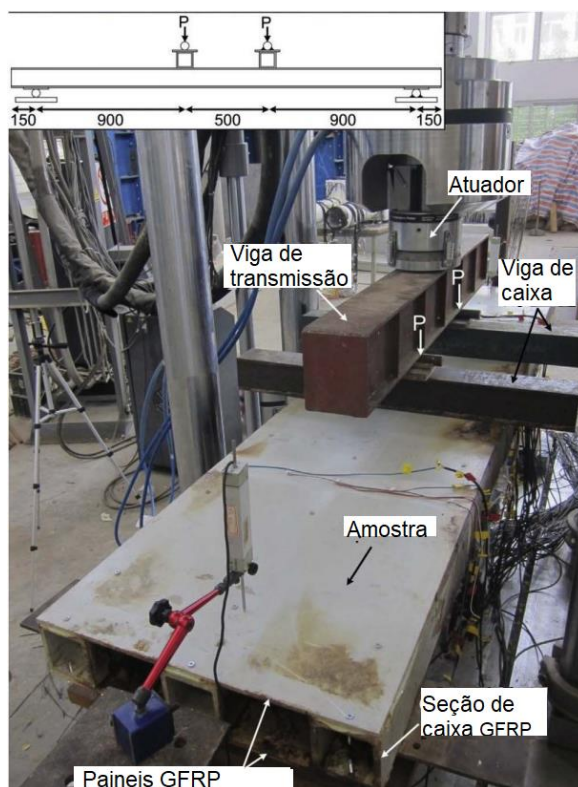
Configuração do ensaio de flexão quatro pontos (em mm) (adaptado de Zhang *et al.*, 2018).
